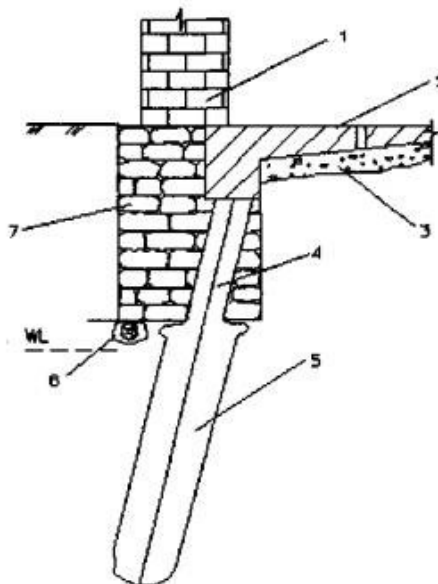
Конструкція короткої палі-шпори і залізобетонної плити: 1 – стіна, 2 – залізобетонна плита, 3 – ін'єкційний цементний розчин, 4 – паля в кондукторі, 5 – розширення палі, 6 – дерев'яний лежень, 7 – бутовий фундамент
